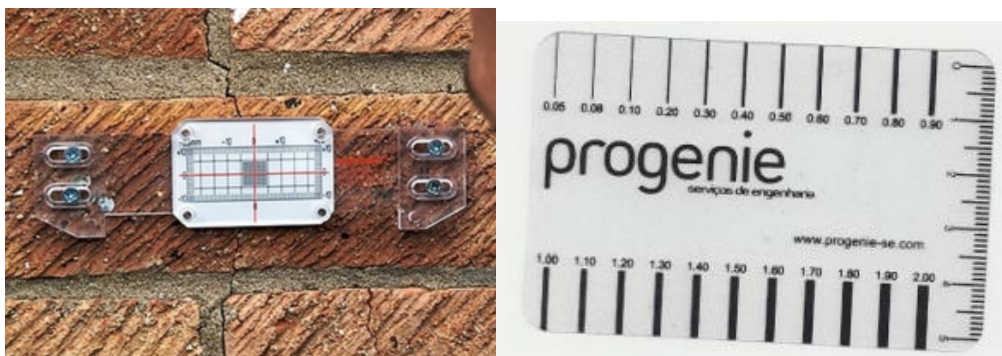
Fissurómetro e comparador de fissuras (W9, W10)
